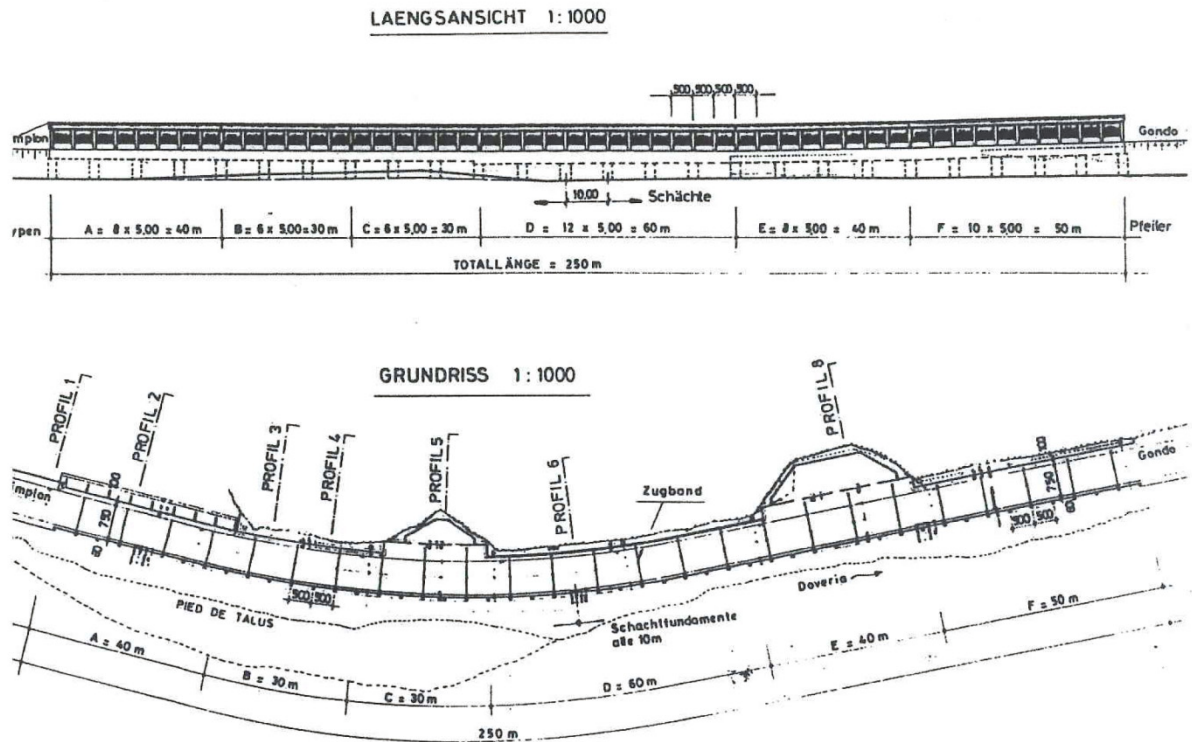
Längsschnitt und Grundriss der betrachteten Galerie.
